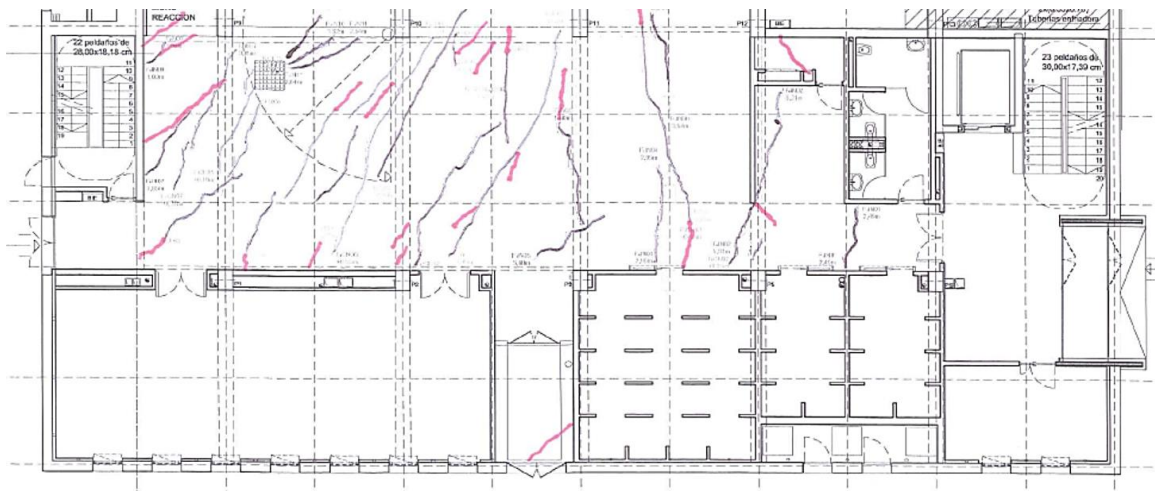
Levantamiento de las fisuras en la cara superior de la losa de 40 cm a fecha de 10/02/2016.
